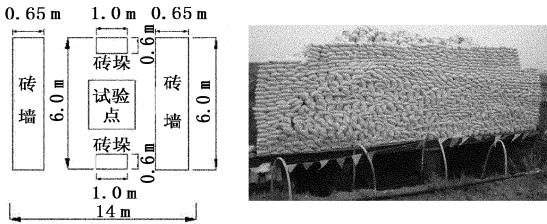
砖墙垒砌方法平面示意图和粉喷桩复合地基静载试验施工现场
